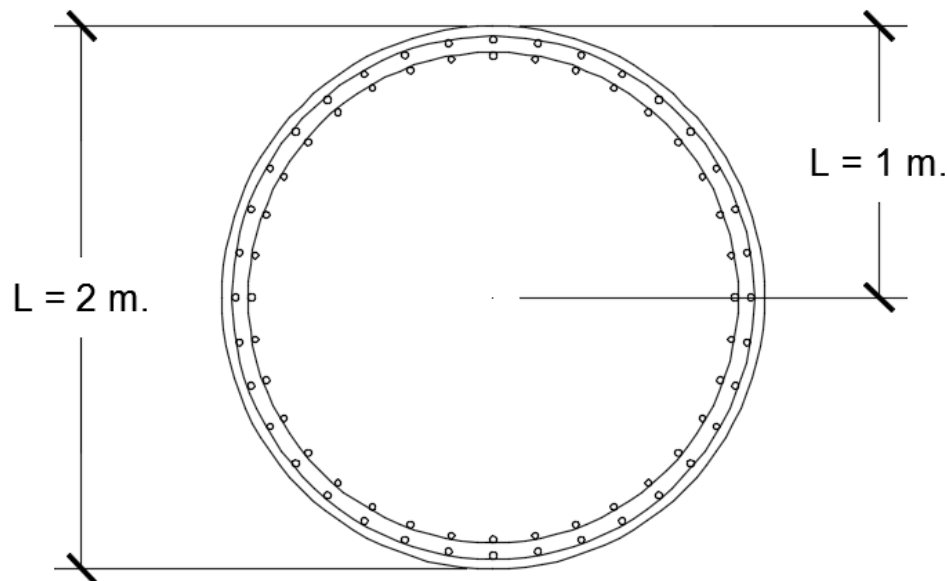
Sección y distribución final de acero para pilar en 2 (Fuente: elaboración propia)
